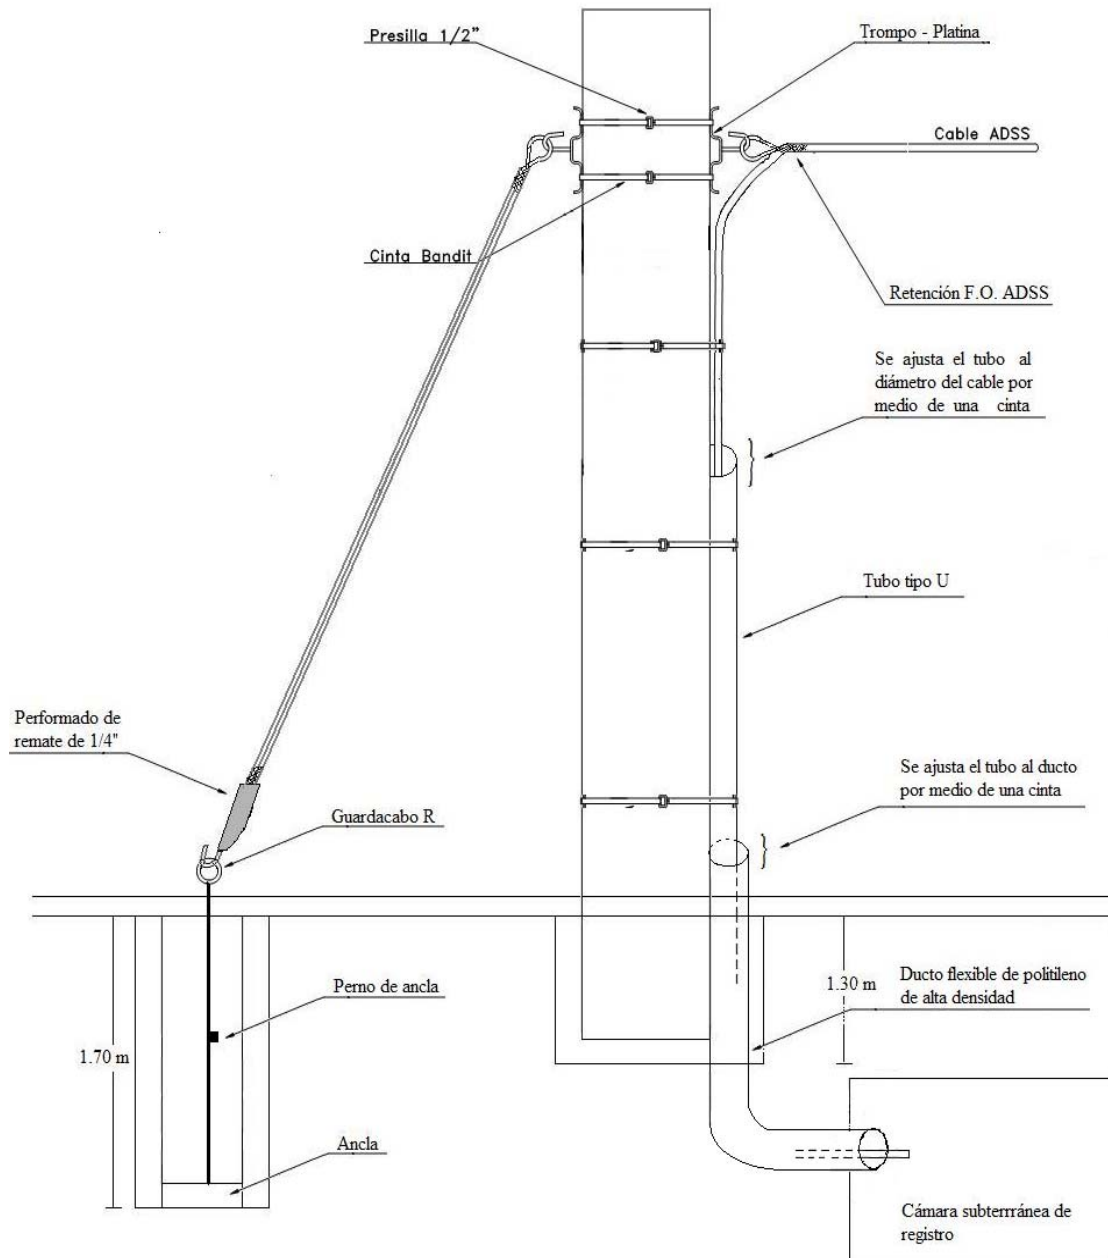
INSTALACIÓN DE FERRETERÍA DE RETENIDA
